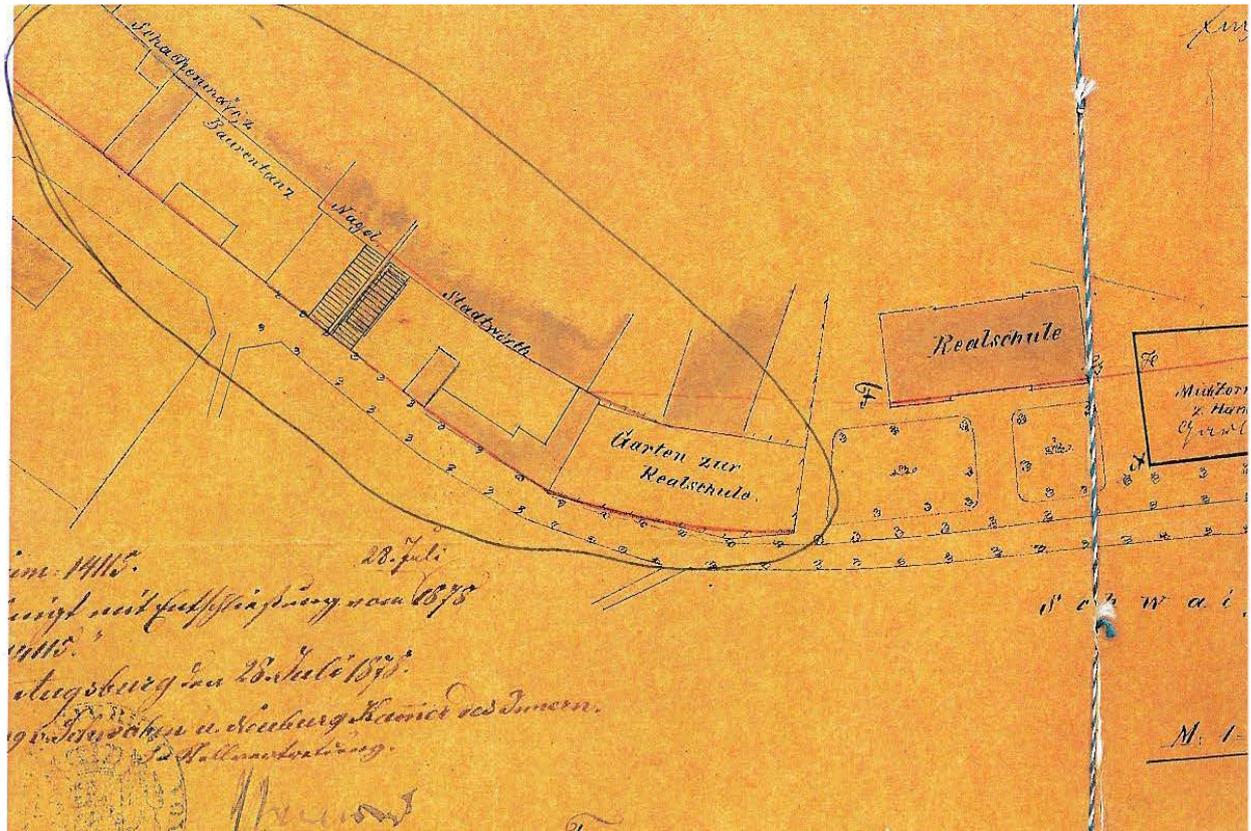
Baulinienplan vom 7.5.1878, Nr. 9, Bereich Promenadestraße/ Königstraße, Stadtplanungsamt Kempten
